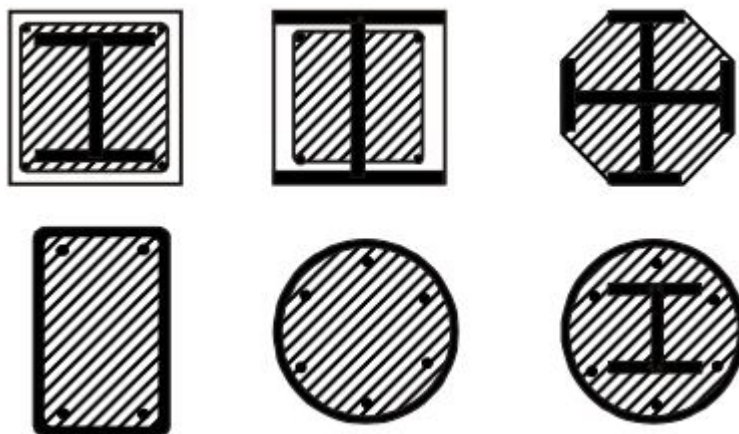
Exemples types de sections transversales de poteaux mixtes [69].
